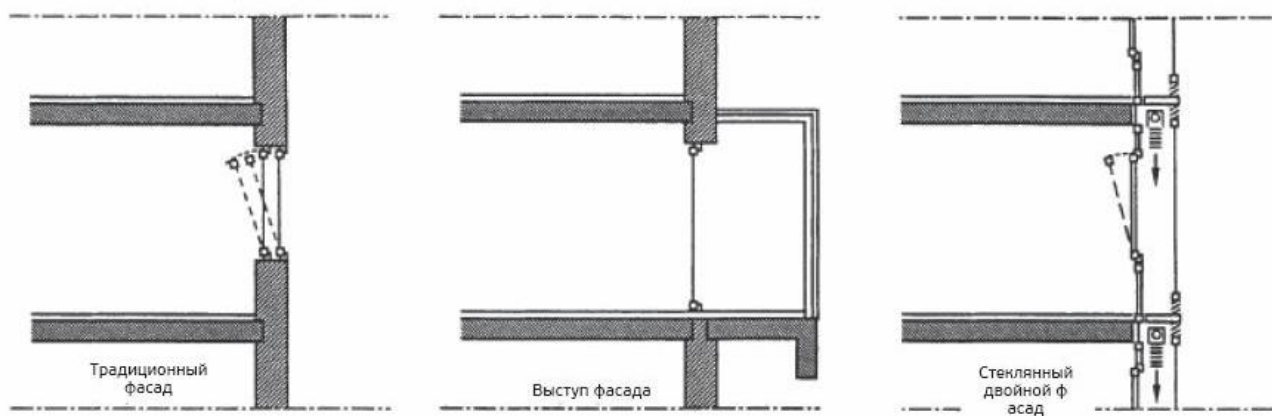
Преобразование традиционного фасада через переходную схему с выступом в стеклянный двойной фасад
